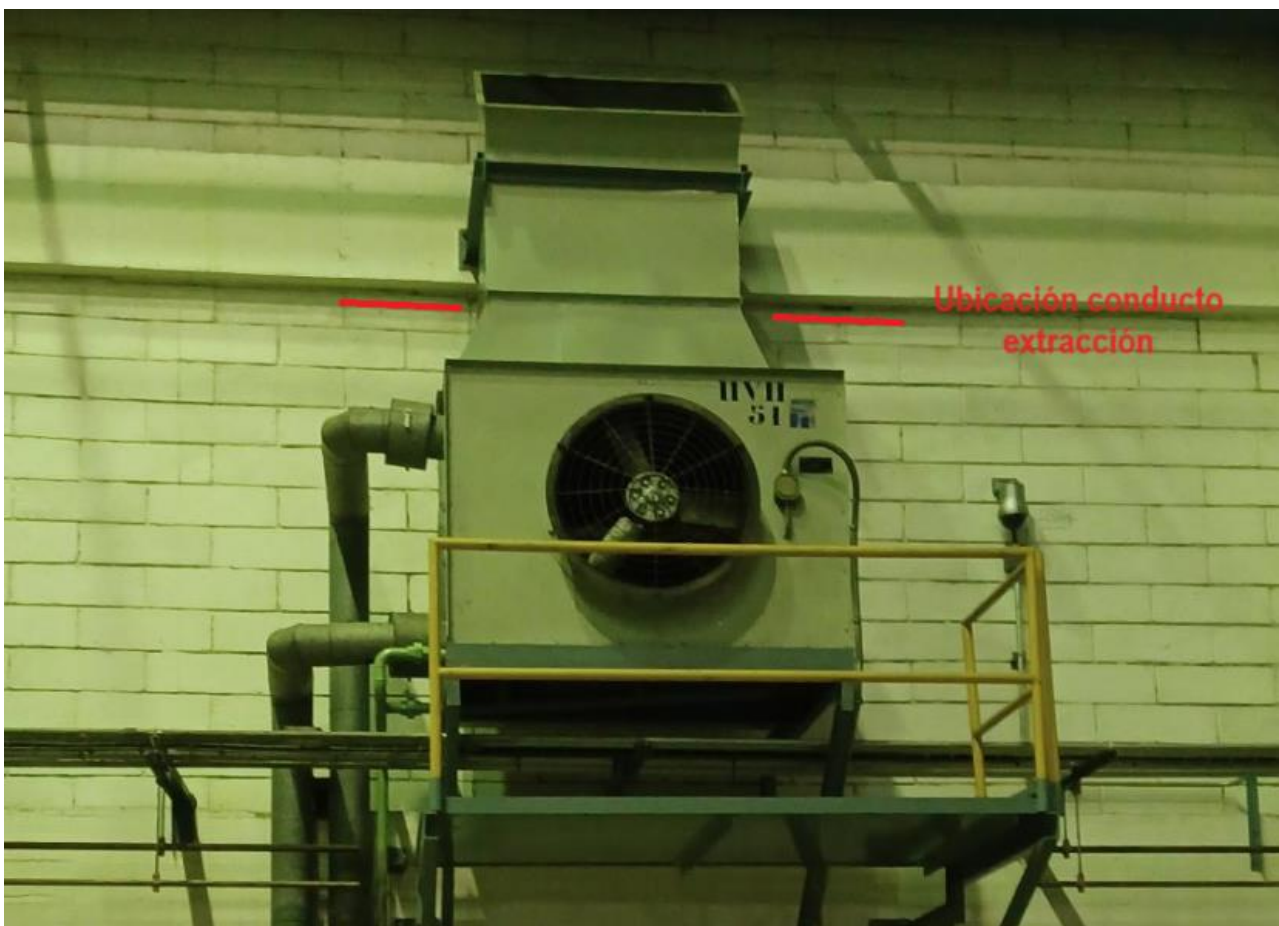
Muro sur POT, detalle "fan coil" HVH-51
